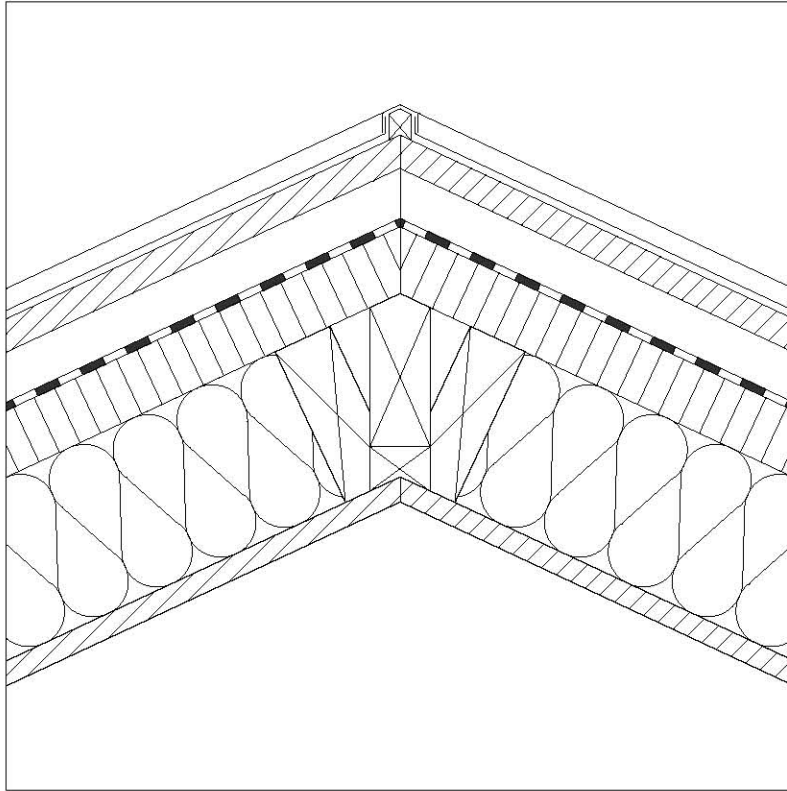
SISTEMA DE PAINÉIS, PORMENOR TELHADO, ESCALA 1:10.
